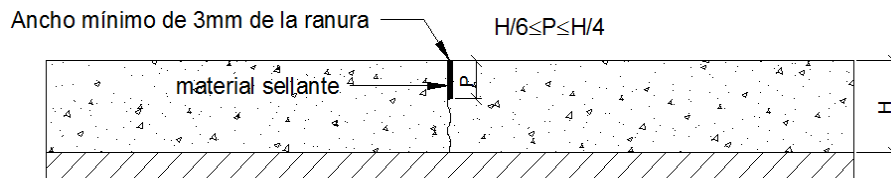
1 Pavimento rígido con junta transversal empleando trabazón de agregados.
